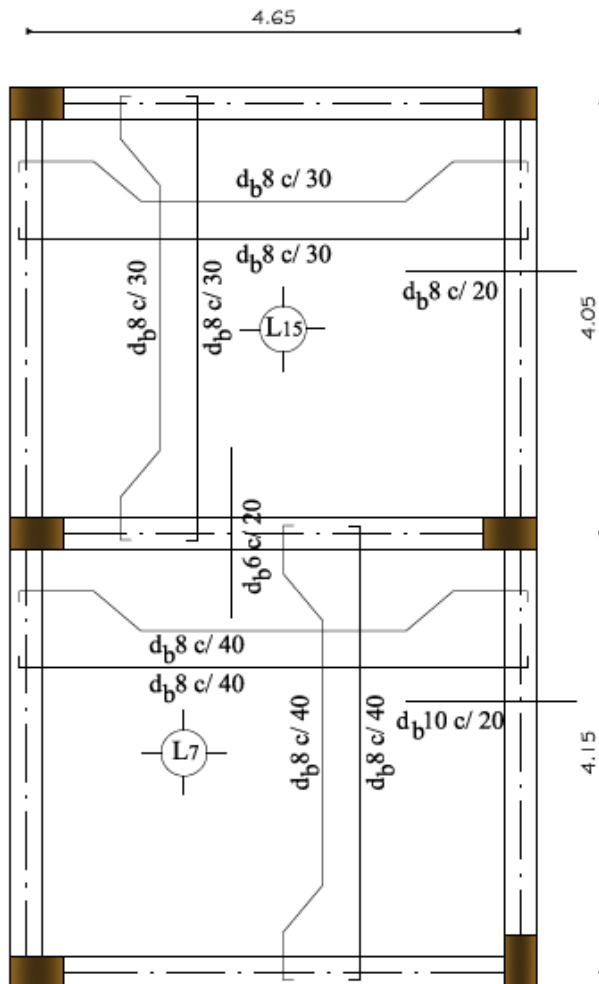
DETALLE DE ARMADURAS DOBLADAS EN LOSA CONTINUA
